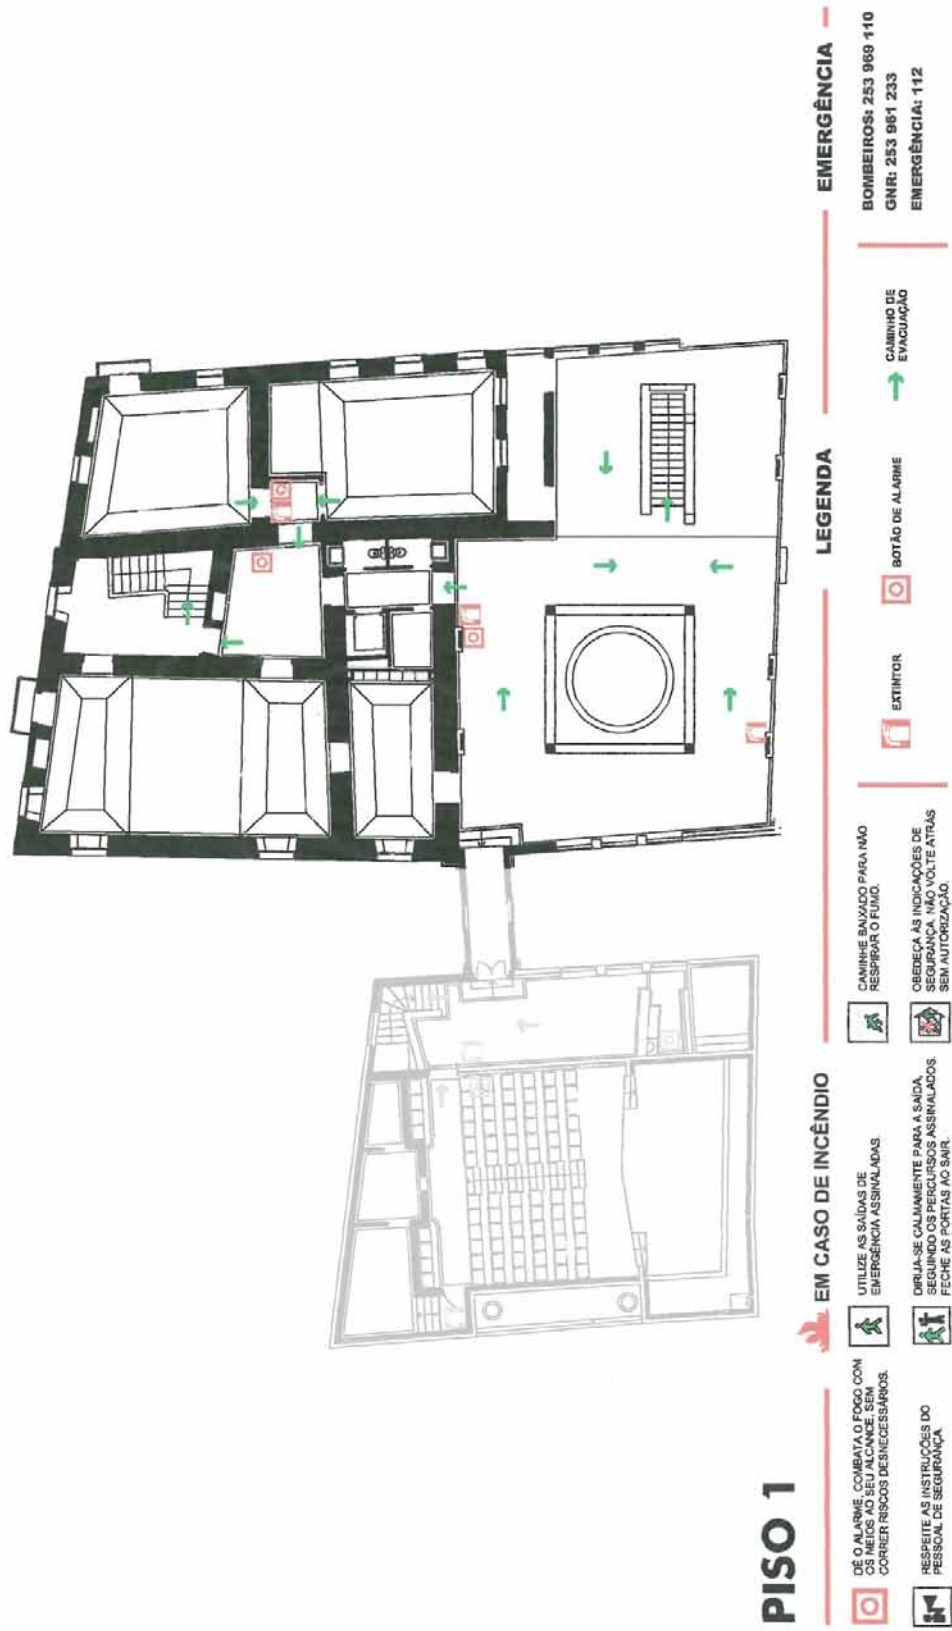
Planta de Emergência Existente (Piso 1)
